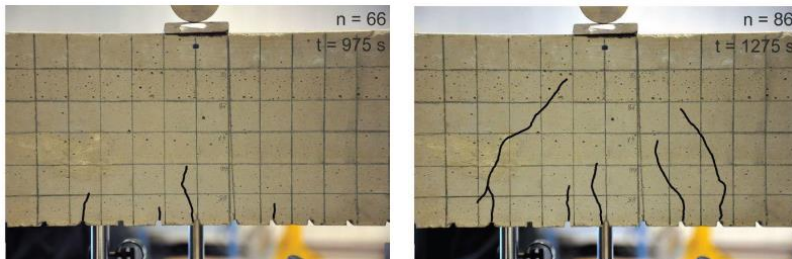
Evolução das fissuras em viga 1.
